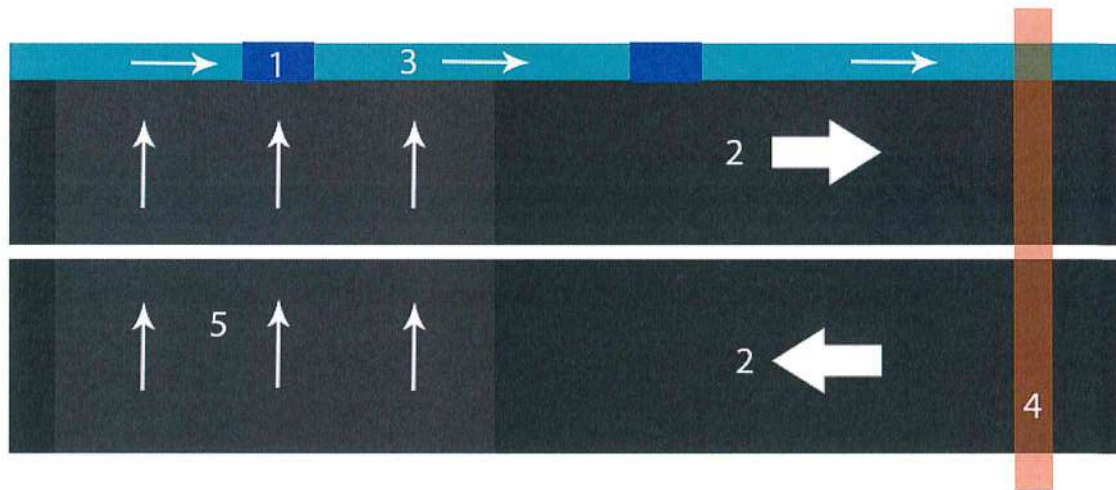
Skema e drenazimit të sipërfaqes së trupit të rrugës
